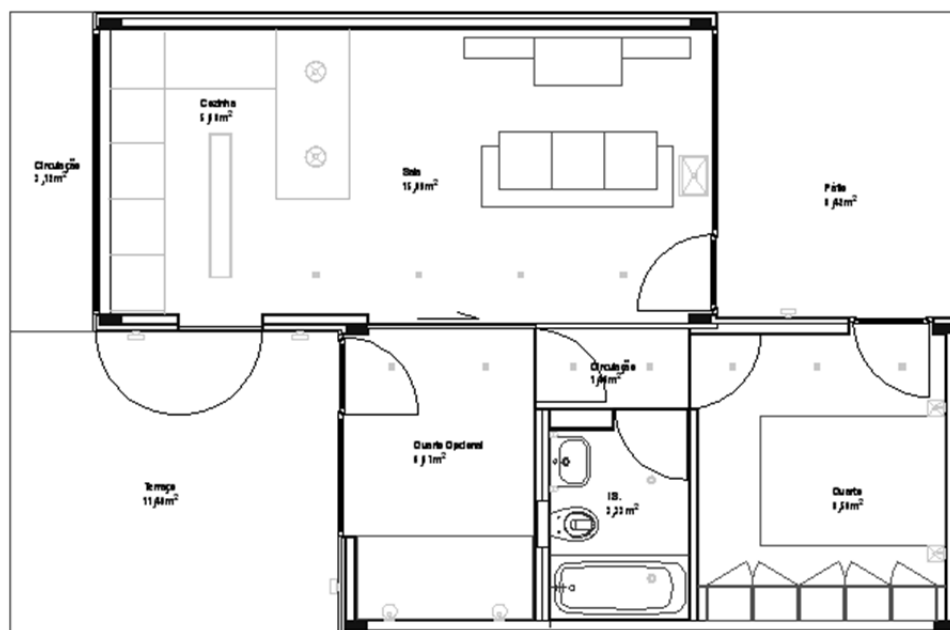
Planta de iluminação do *Green Bungalow
